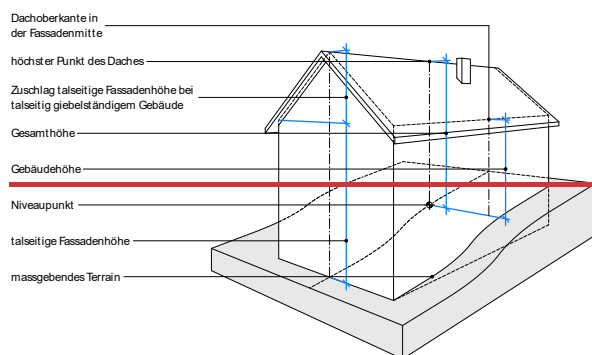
Talseitige Fassadenhöhe gemäss Art. 15 BauR
